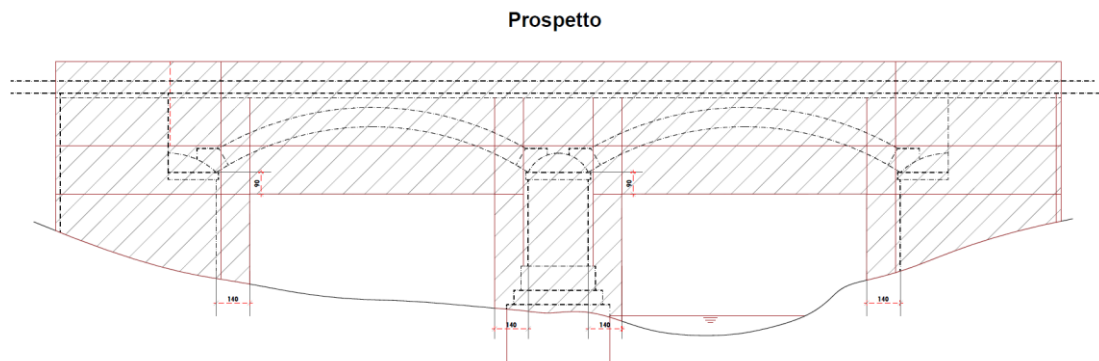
Prospetto ingombro del ponteggio per i lavori di consolidamento del ponte sul T.Lanzo
